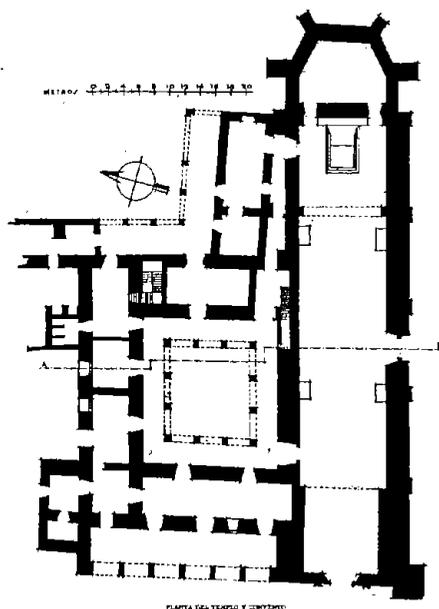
Templo de nave rasa, Planta del Convento de Dzidzantun.
